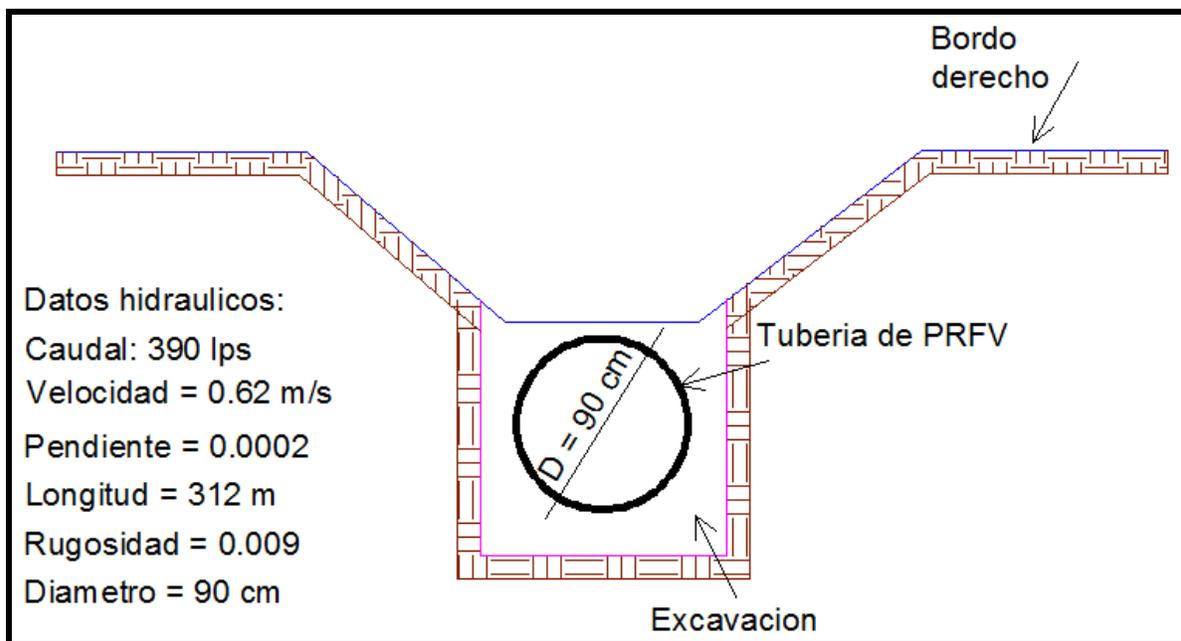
Alternativa 4 (entubado con tubería flexible de 36" de diámetro de PRFV.)
